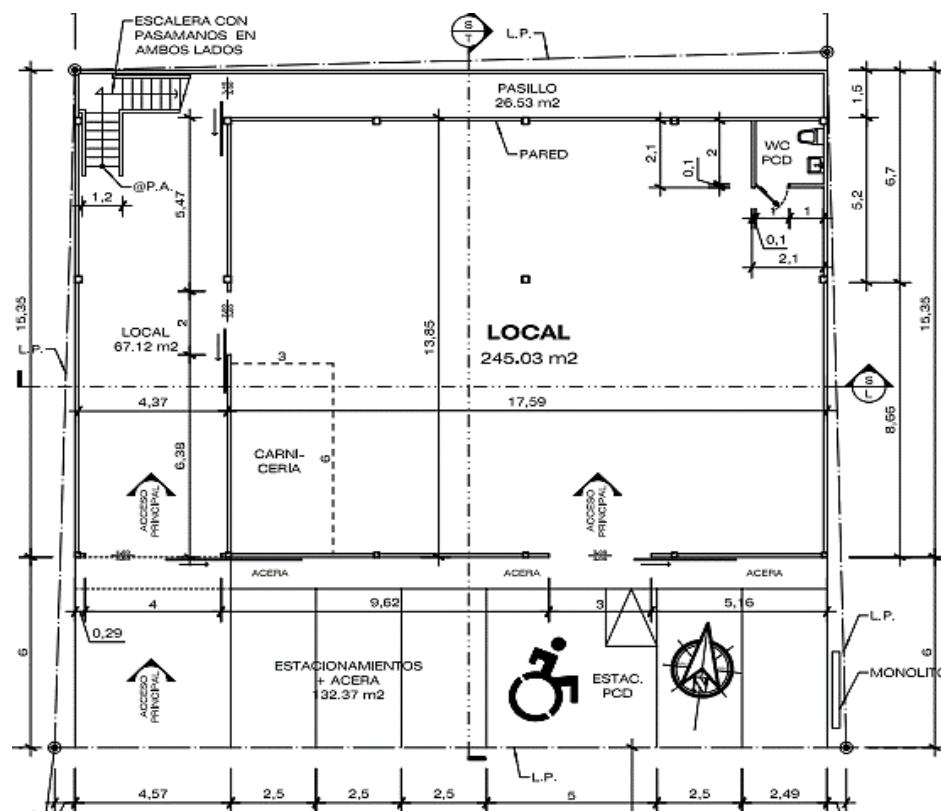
Vista superior de la planta baja del edificio. Fuente: Planos proporcionados por el promotor.
